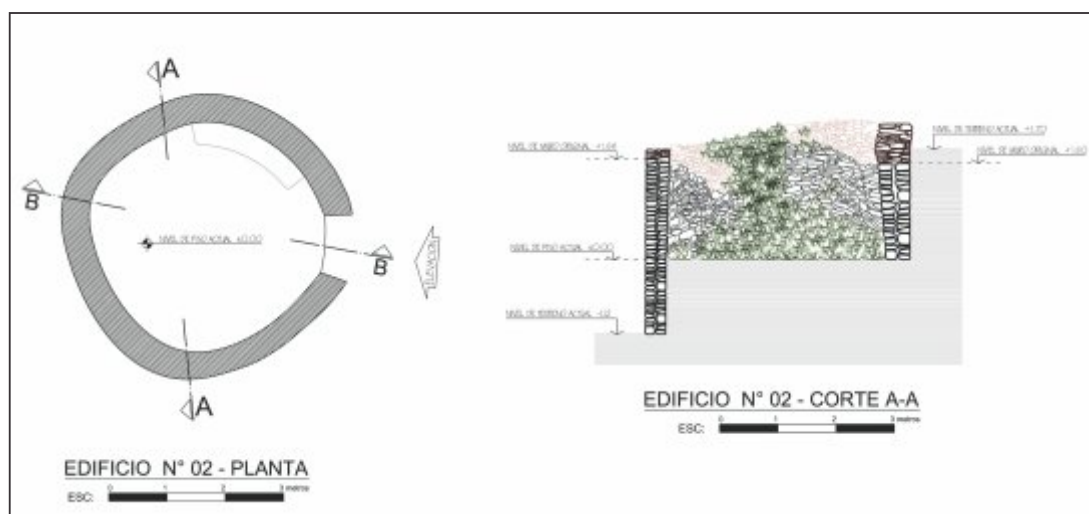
Planta y corte norte-sur (A-A) del edificio 02 en El Obraje 02, mostrando parte de su sistema estructural, los muros originales y los reconstruidos, además de la vegetación existente (Esc. 1:100).
